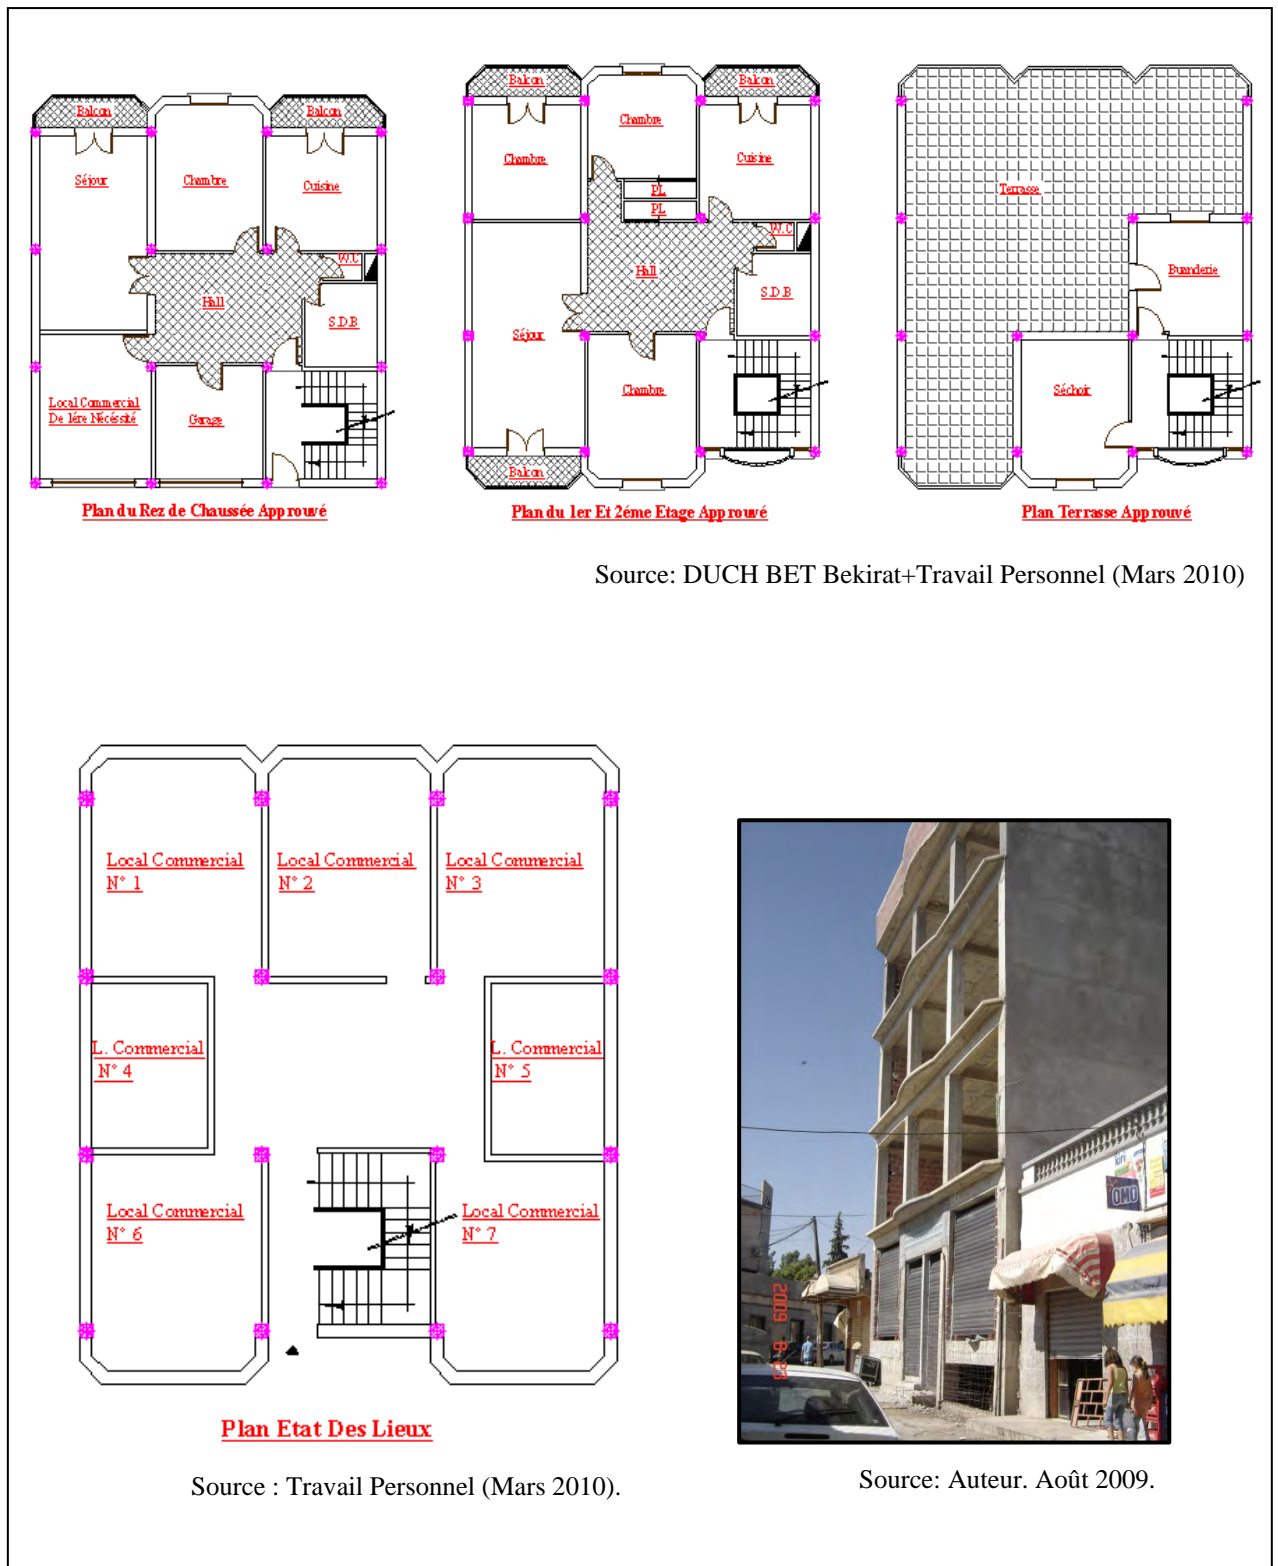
Premier exemple d'une maison; la non conformité des plans aux permis de construire.
